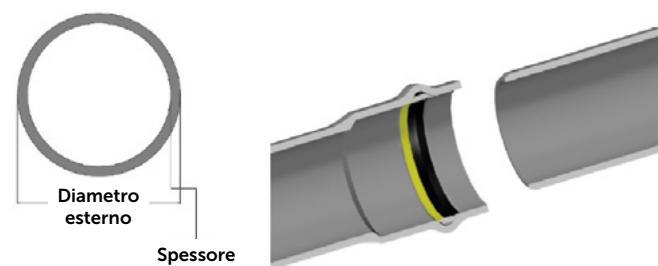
Sezione trasversale di un tubo in PVC e dell'estremità a campana con guarnizione elastomerica (da: System Group, modificato).
